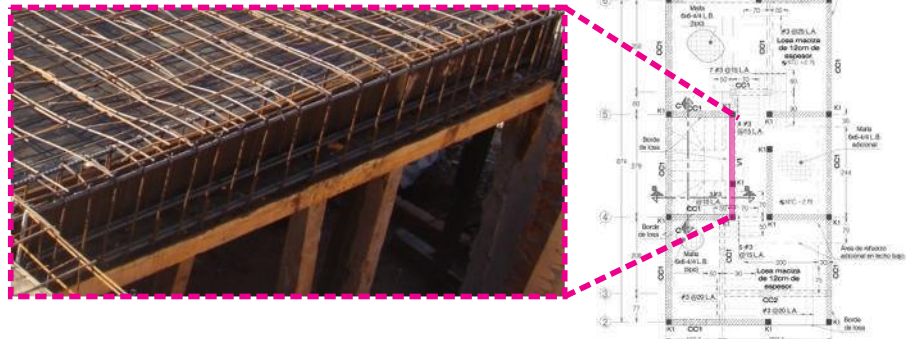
VIGA V1 COLOCADA EN EL ARMADO DE ENTREPISO (SAUCE).
